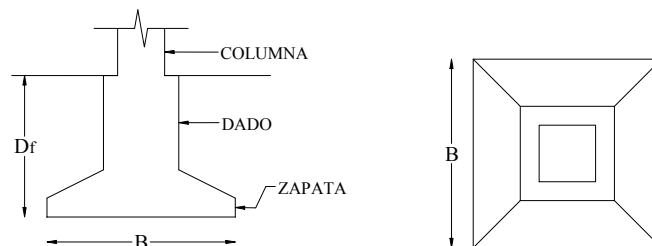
Planta y perfil de una zapata aislada, (Rivera Constantino).
